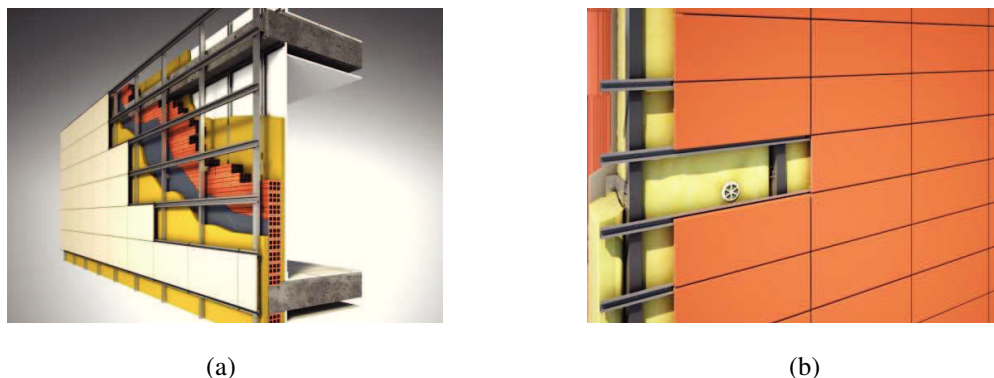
Sistema de fachada ventilada (a)[W3], (b) [W4]
